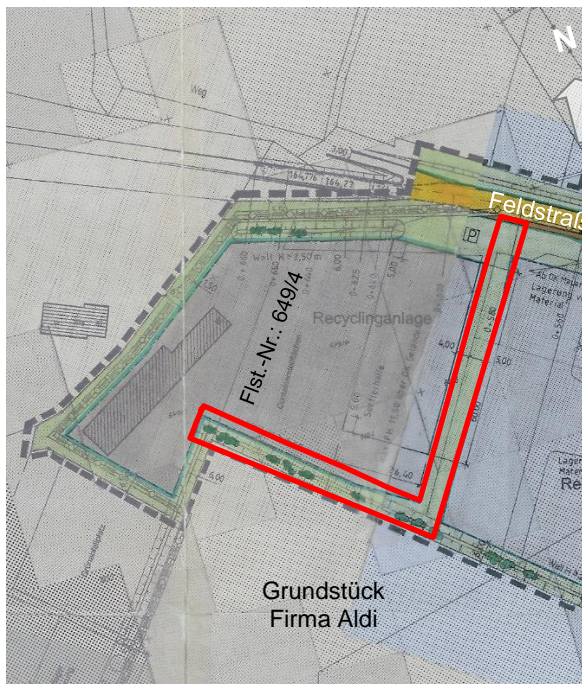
Bebauungsplan „Feldstraße“ i. d. F. Rechtskraft mit Änderungsbereich (schematische Darstellung)
